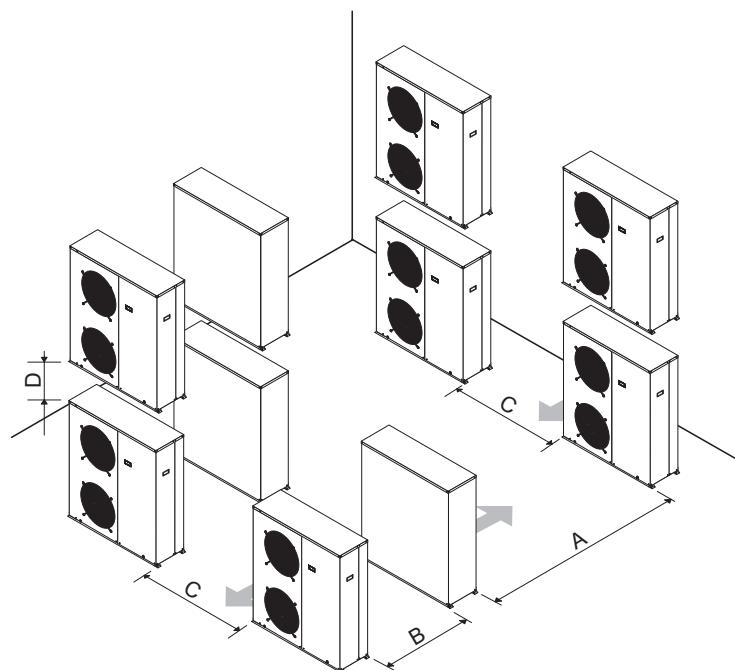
dégagements minimum d'installation des unités sur différents niveaux.
